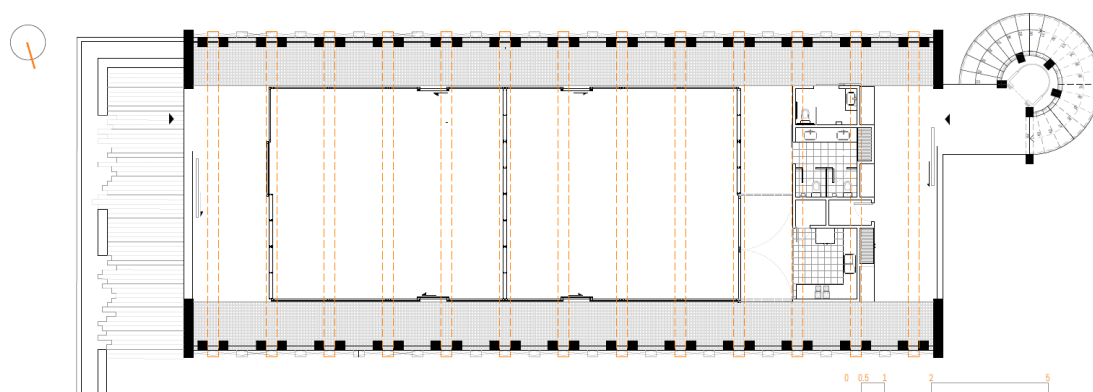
Esquema de planta libre en la segunda planta. Fuente: elaboración propia.
